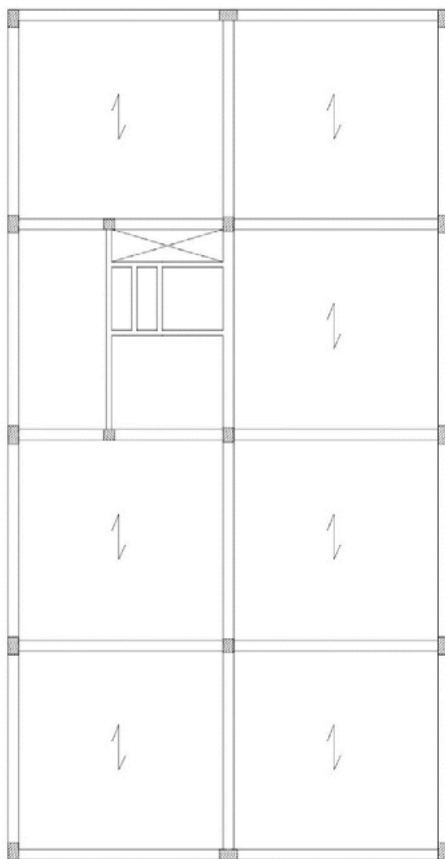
Planta baixa do pavimento tipo do modelo em concreto armado pré-fabricado.
